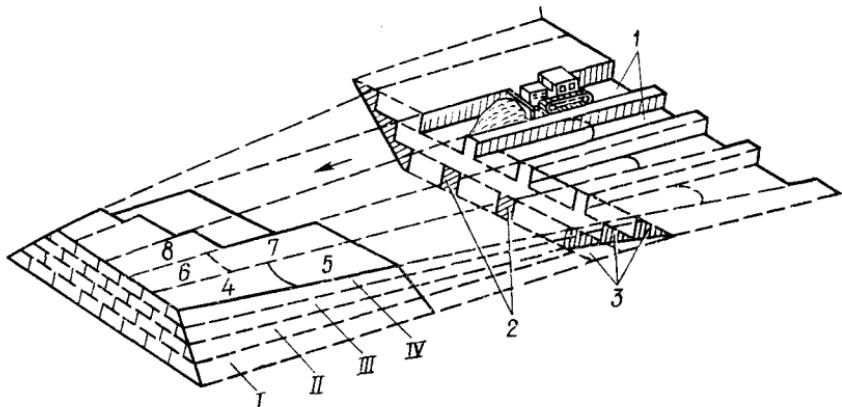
Разработка грунта бульдозером с перемещением в насыпь продольными проходами:
